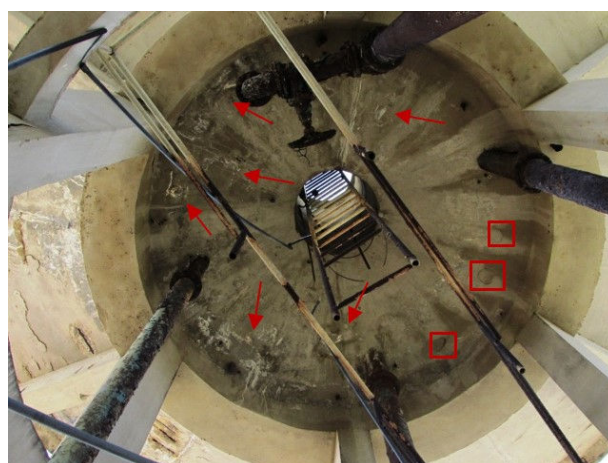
Vista da laje inferior da cuba com infiltração principalmente nas bordas, em destaque zonas com deslocamento de concreto iminente (retângulos) e eflorescências (setas)
